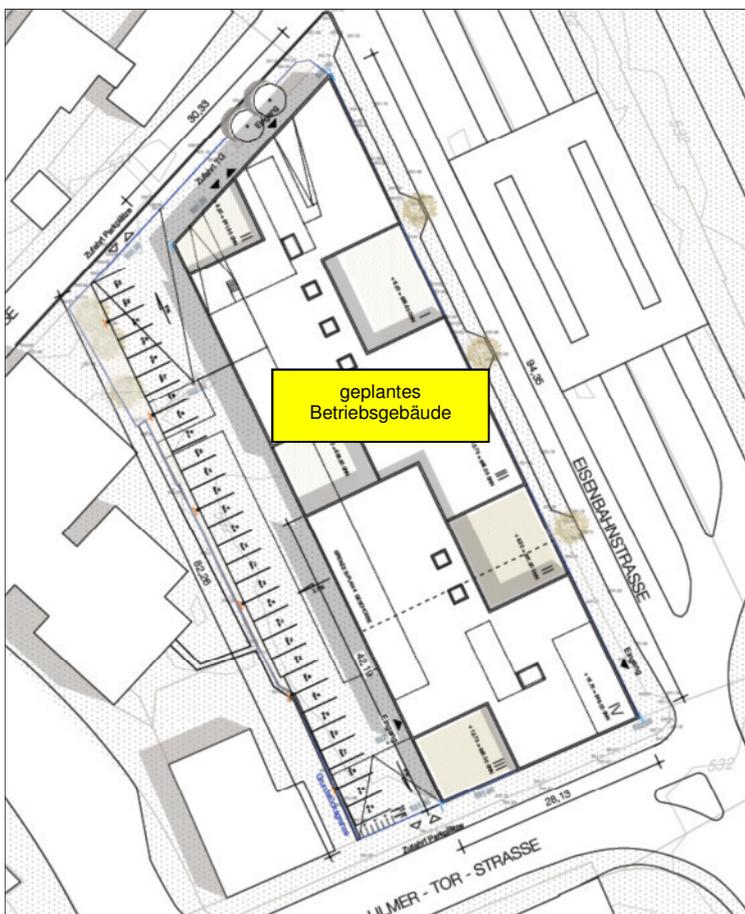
Lageplan mit Darstellung des Bauvorhabens gemäß [c]
